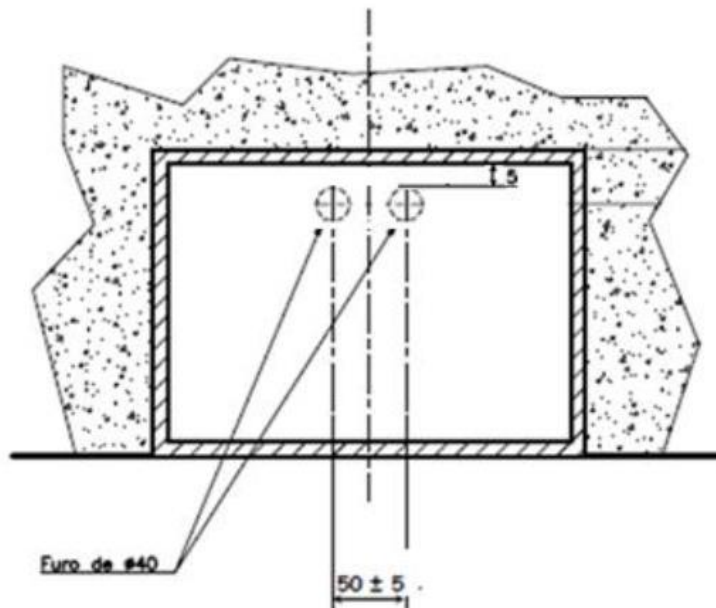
Caixa Platine (vista de baixo) – Localização das aberturas para passagem dos cabos
